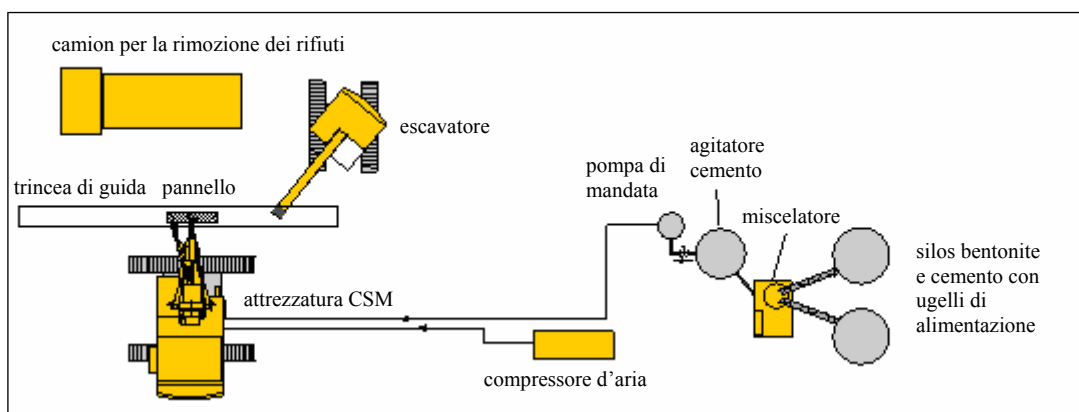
Schema in pianta del cantiere per la procedura con sistema mono-fase.
